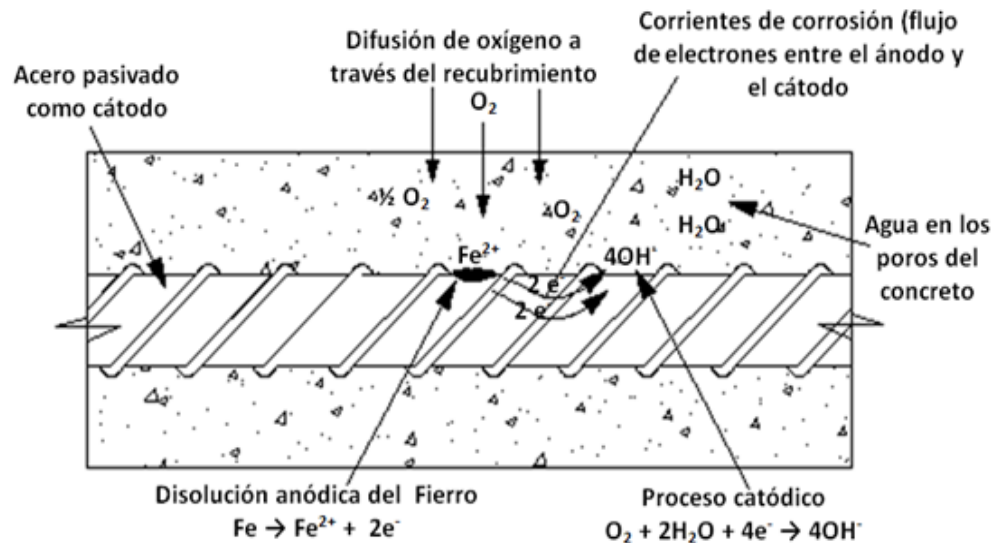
Formación de la pila de corrosión en el concreto reforzado en ambientes alcalinos (Borges, 2001).
